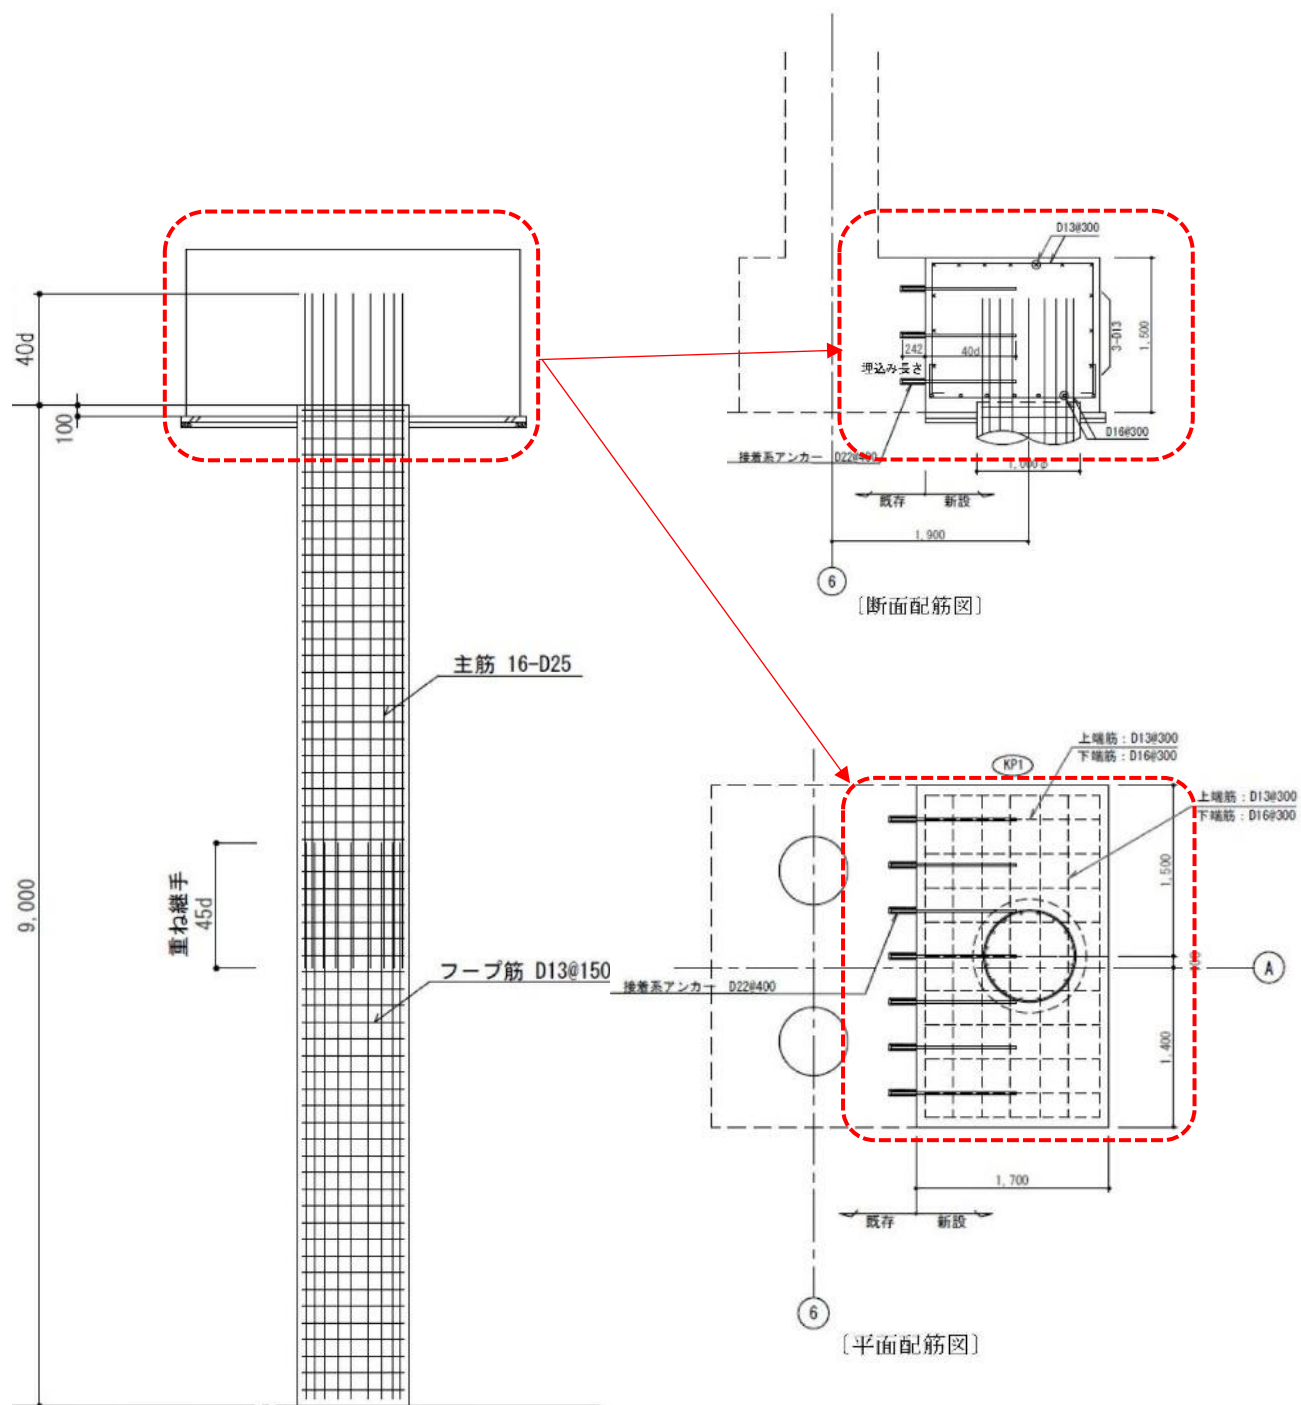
第3廃棄物処理棟の杭 施工詳細図
